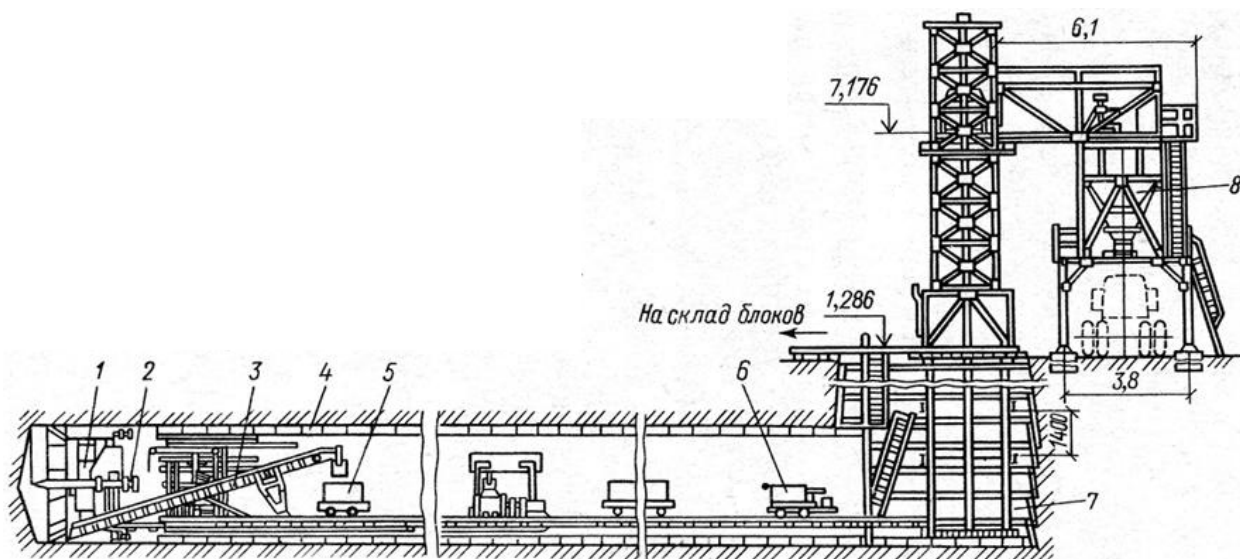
Схема щитовой проходки: 1 – щит; 2 – эректор; 3 – ленточный перегружатель; 4 – обделка туннеля (тубинги); 5 – вагонетка; 6 – электровоз; 7 – ствол вертикальной шахты; 8 – раздаточный бункер-накопитель грунта.
